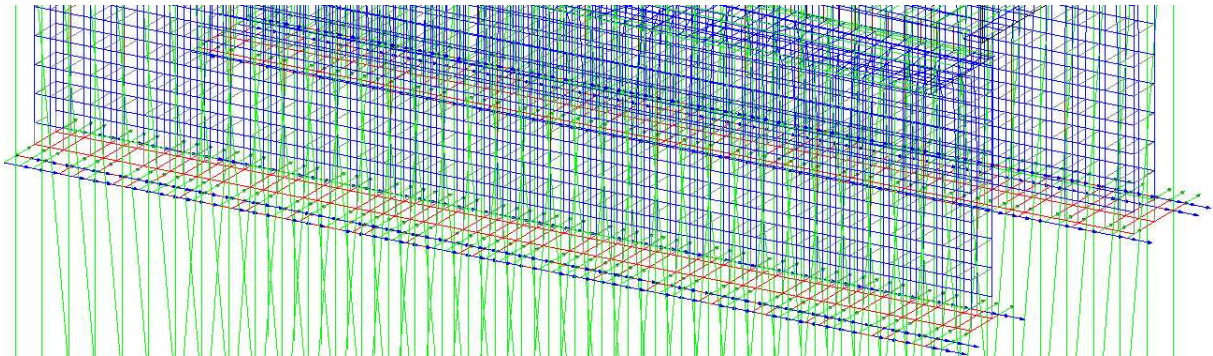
Vincolamento dei nodi appartenenti alle fondazioni delle spalle esistenti
